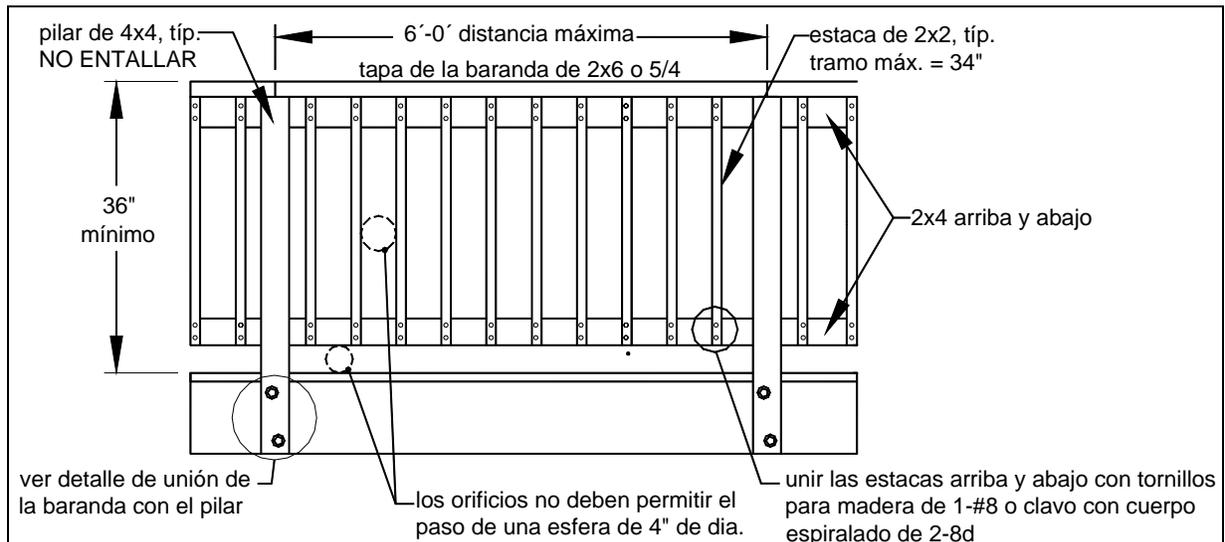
DETALLE TÍPICO SOBRE BARANDAS
